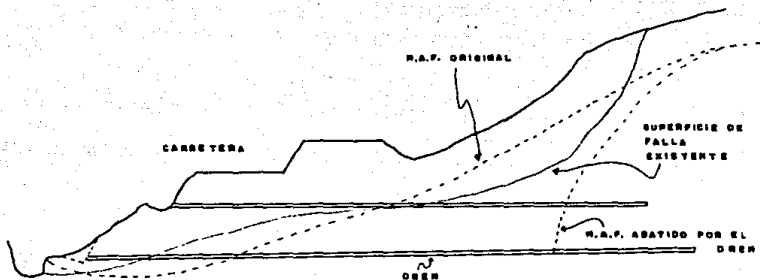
Drenes transversales de penetración para la corrección de una falla existente .
